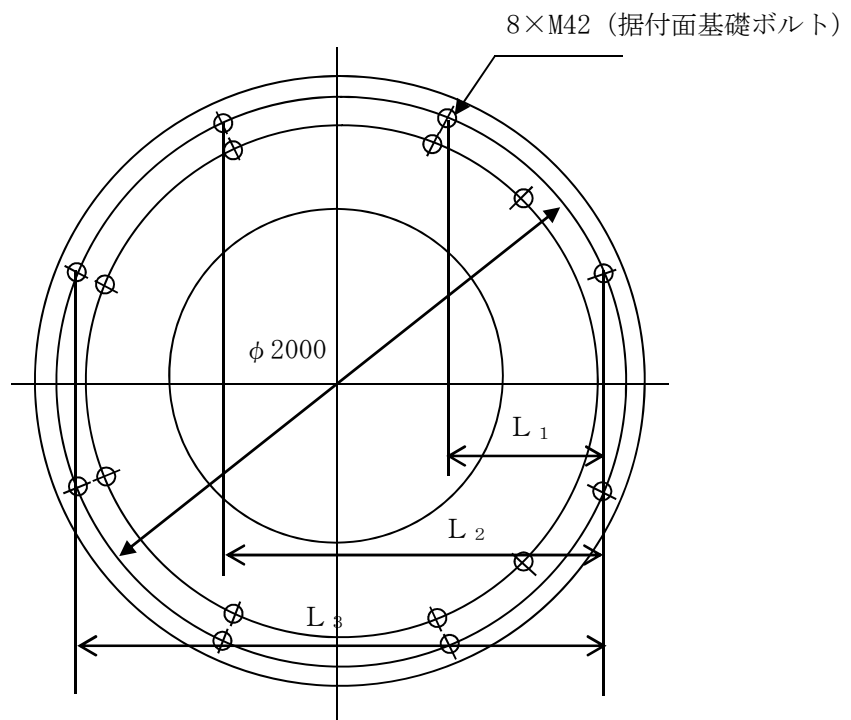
据付面基礎ボルト*の各ボルト間寸法の配置図
